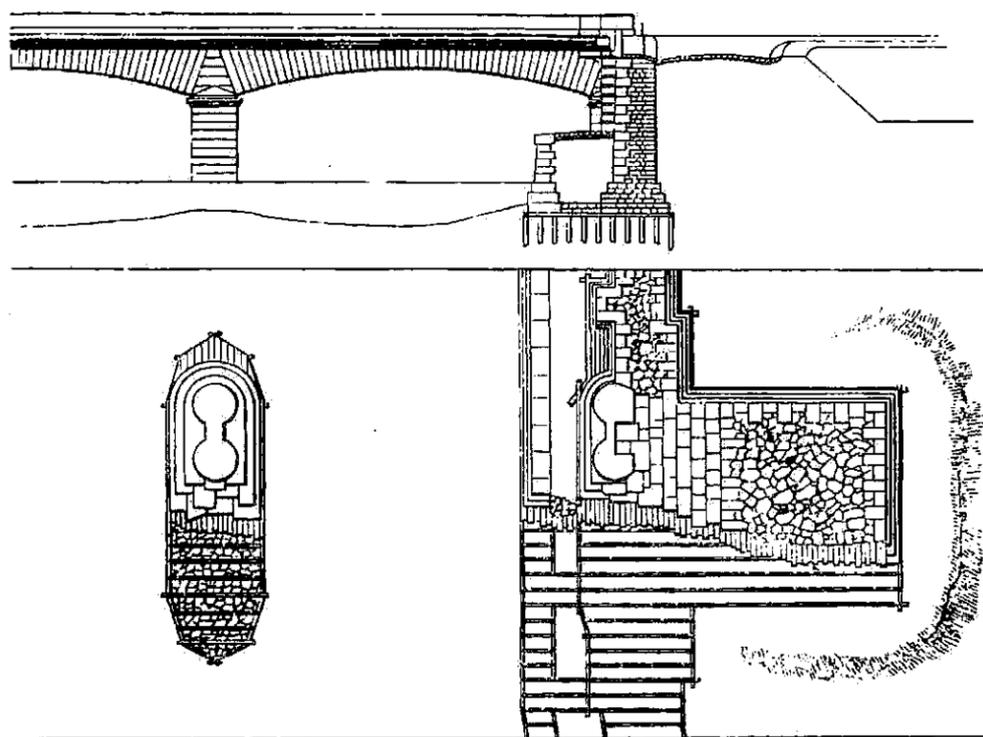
佩罗内特建于圣马克桑斯的桥。(上)立面图;(下)平面图。
